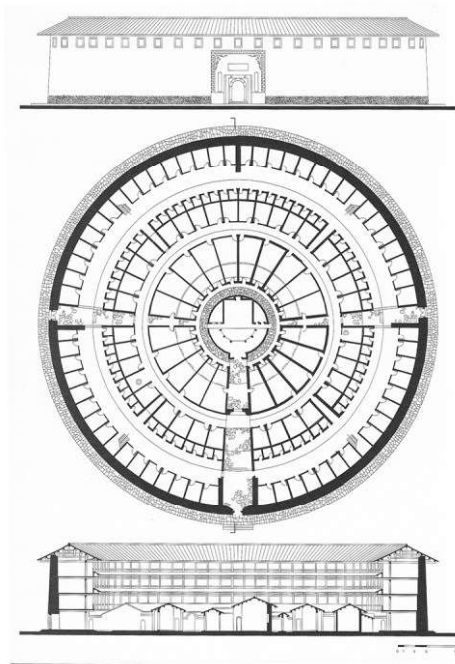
Prospetto, pianta e sezione del *Cheng Qi lou tulou*. (Greco, 2003: p. 58)
